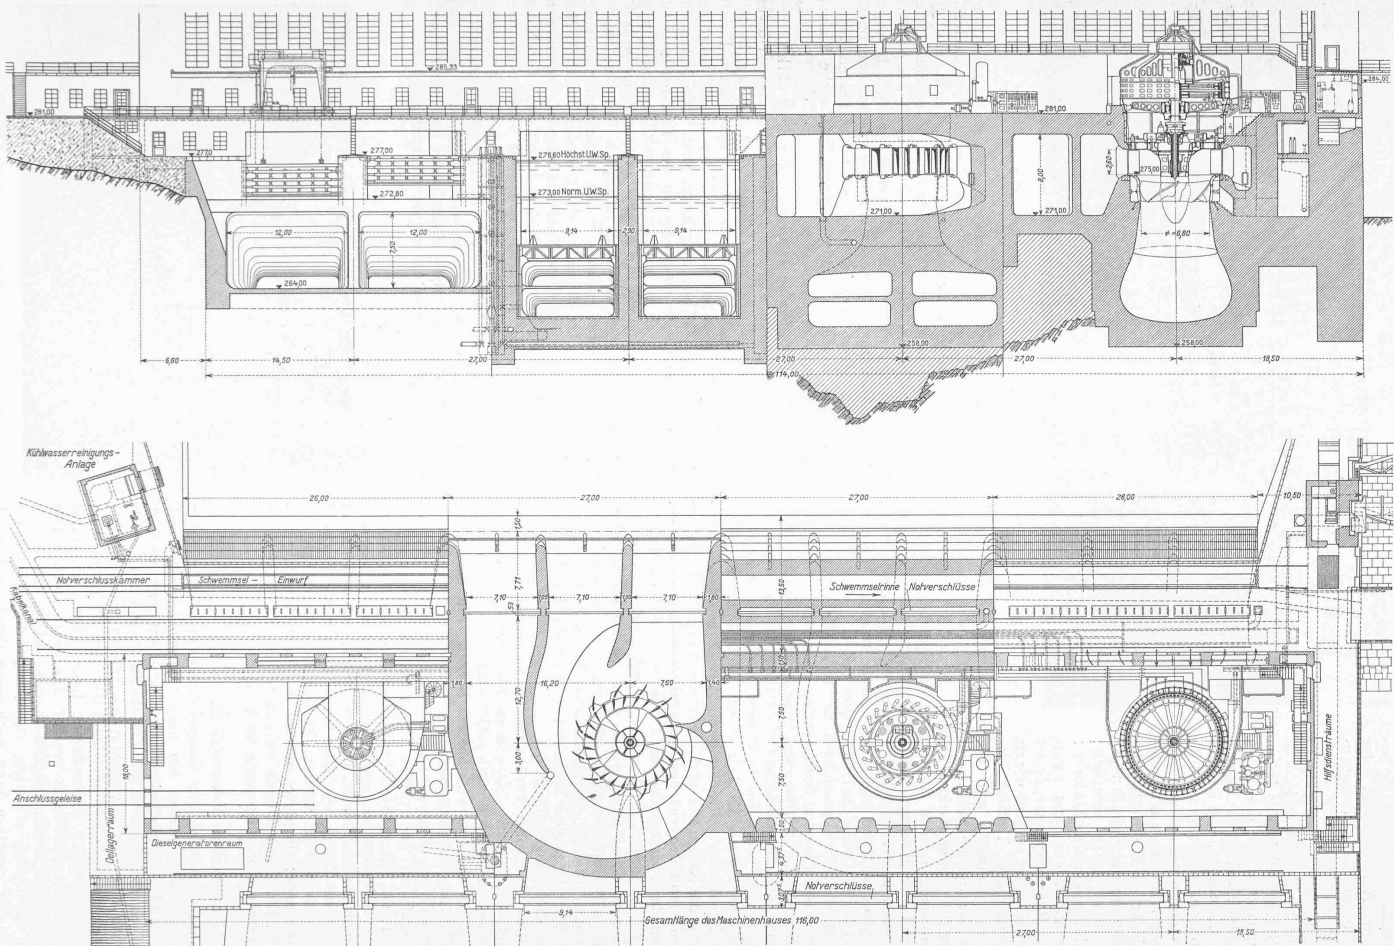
Abgestufter Längsschnitt durch Saugrohre und Maschinenhaus, von der Unterwasserseite aus gesehen; darunter abgestufter Horizontalschnitt durch Einlauf und Maschinenhaus — Masstab 1 : 500.
